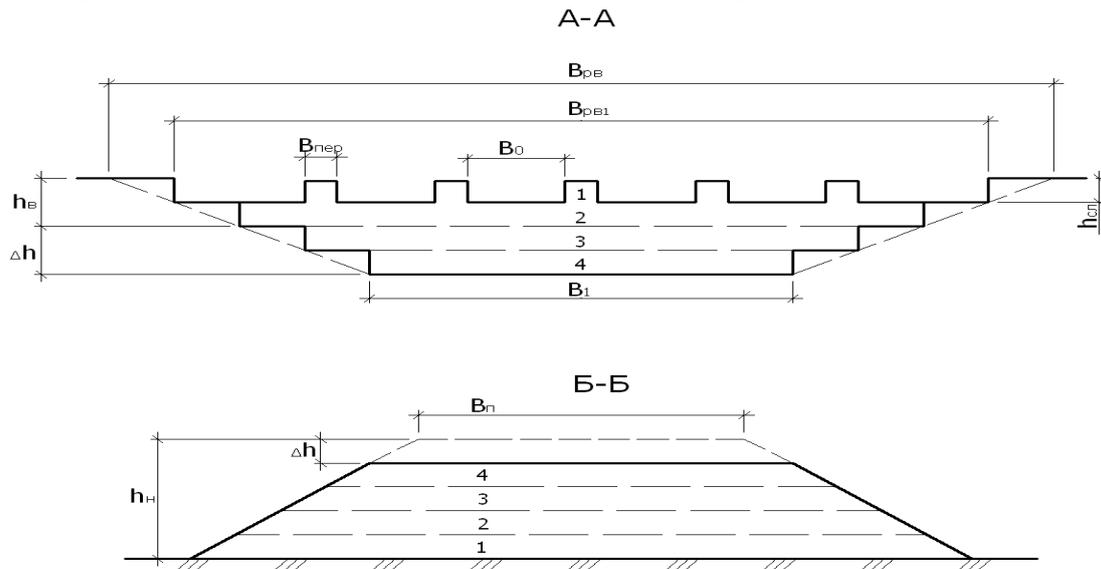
Схема разработки выемки и отсыпки насыпи бульдозером
